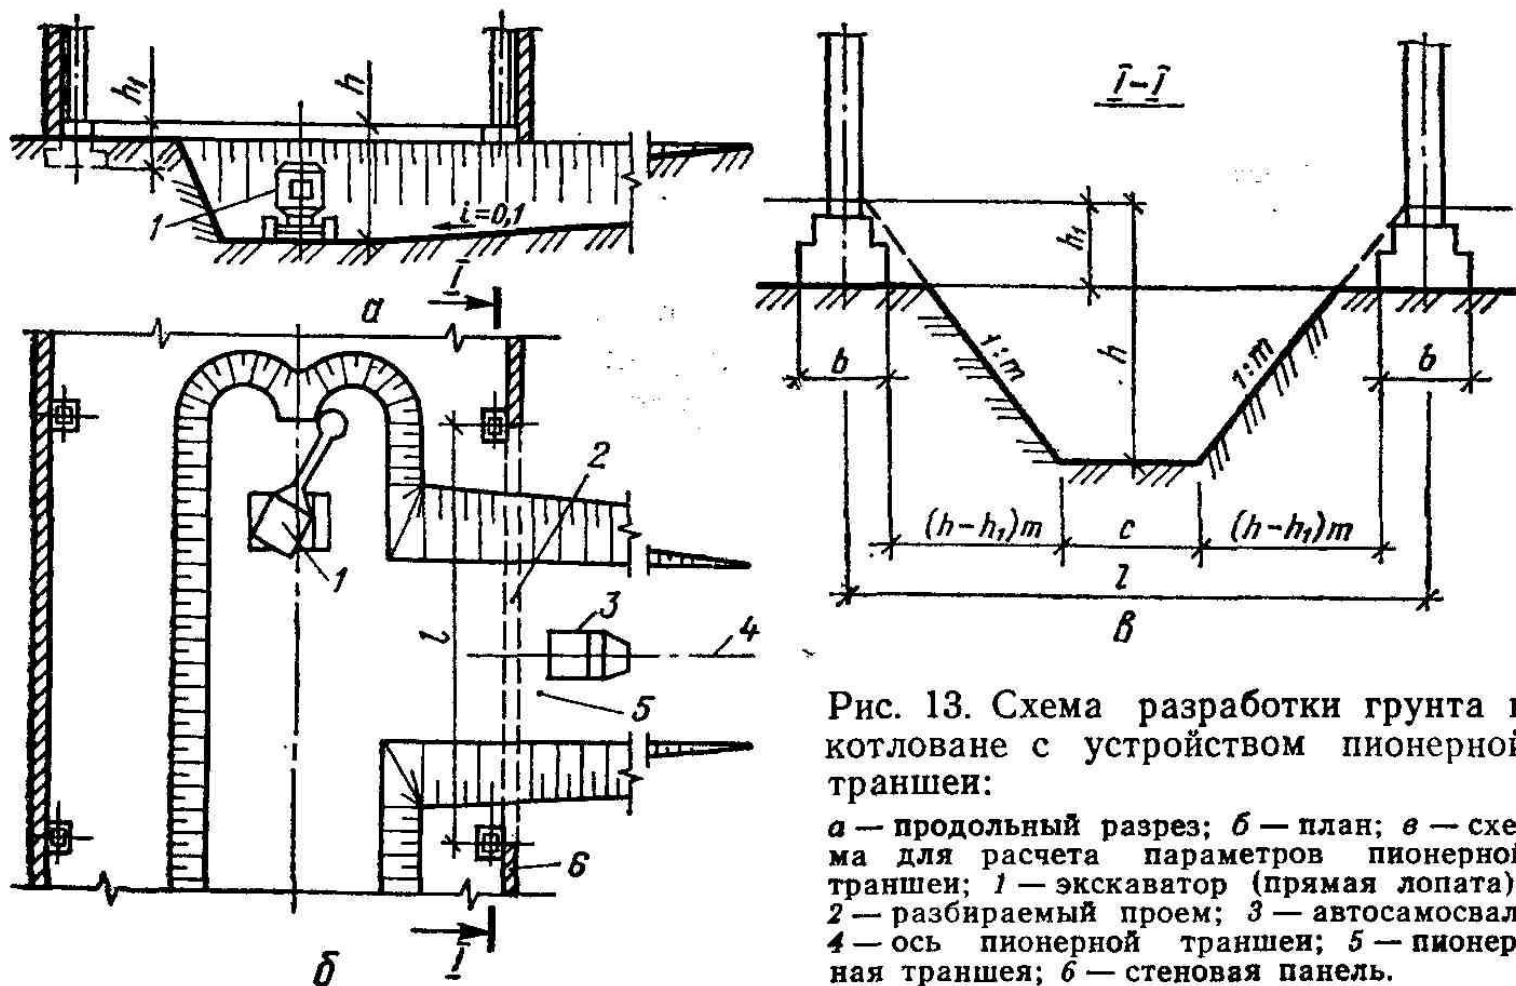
Схема разработки грунта в котловане с устройством пионерной траншеи:
